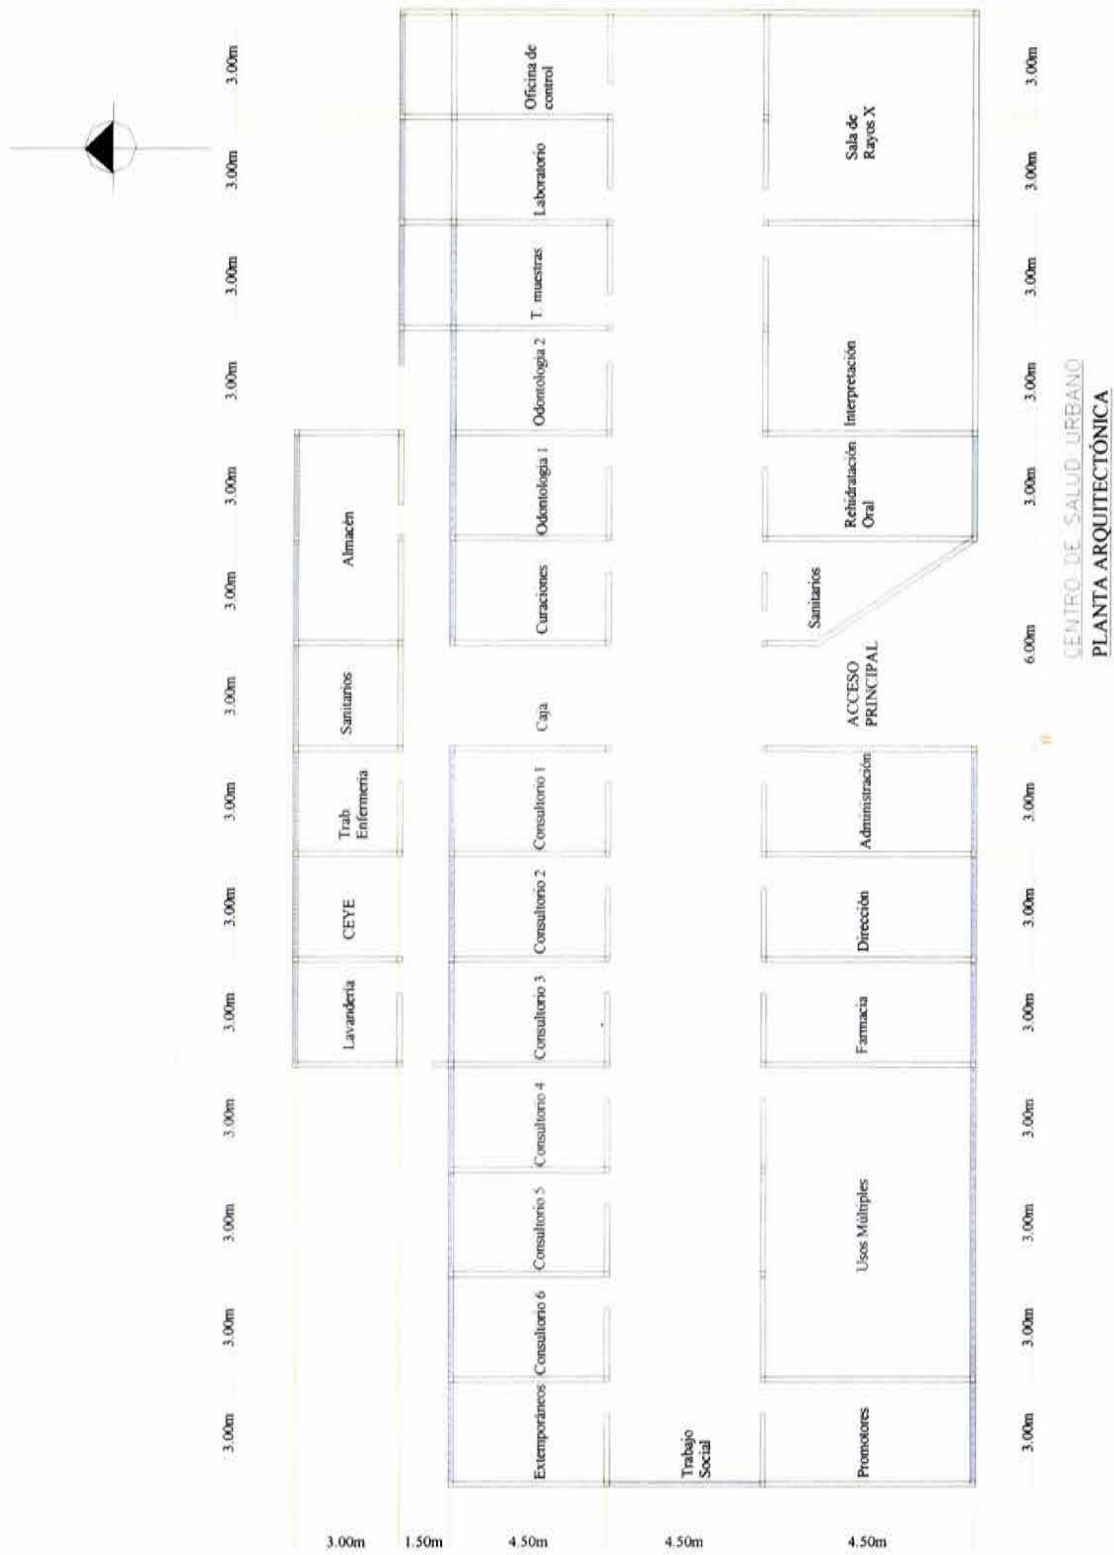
Planta arquitectónica de la edificación de estudio
